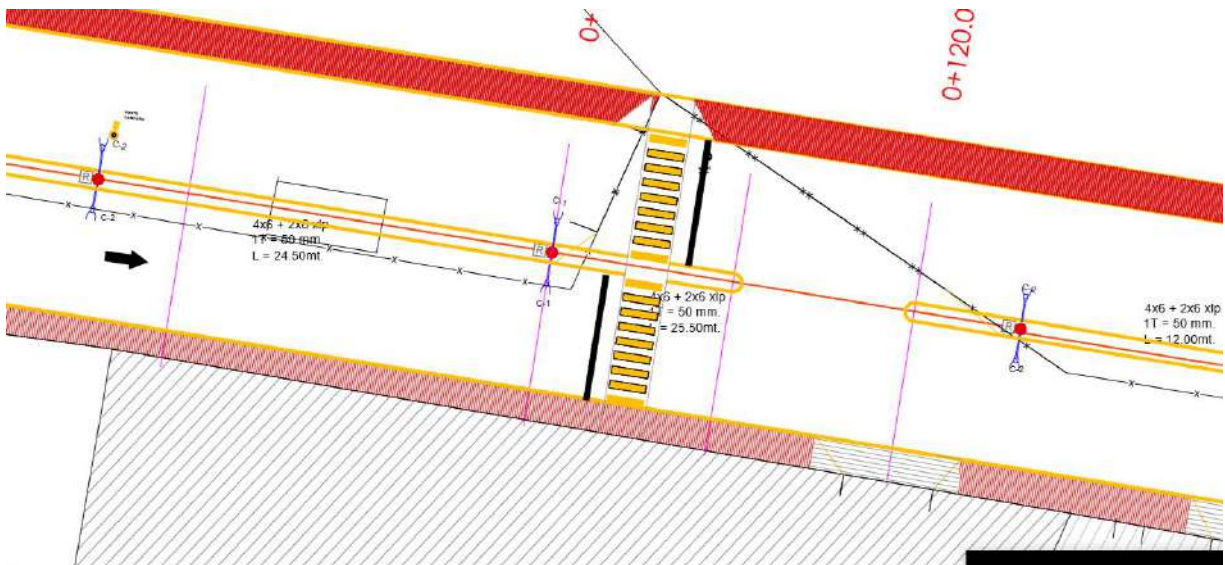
Detalle de energía eléctrica calle Viznaga. Planos de alumbrado de la calle.
